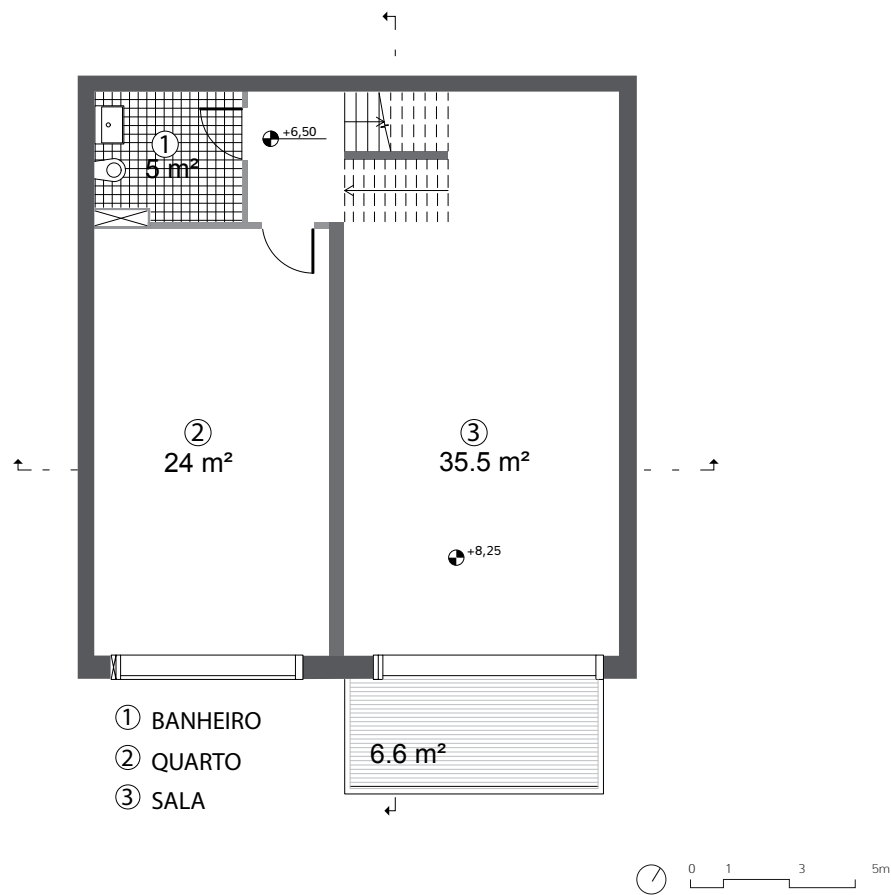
Planta baixa terceiro pavimento - *Penthouse*.
